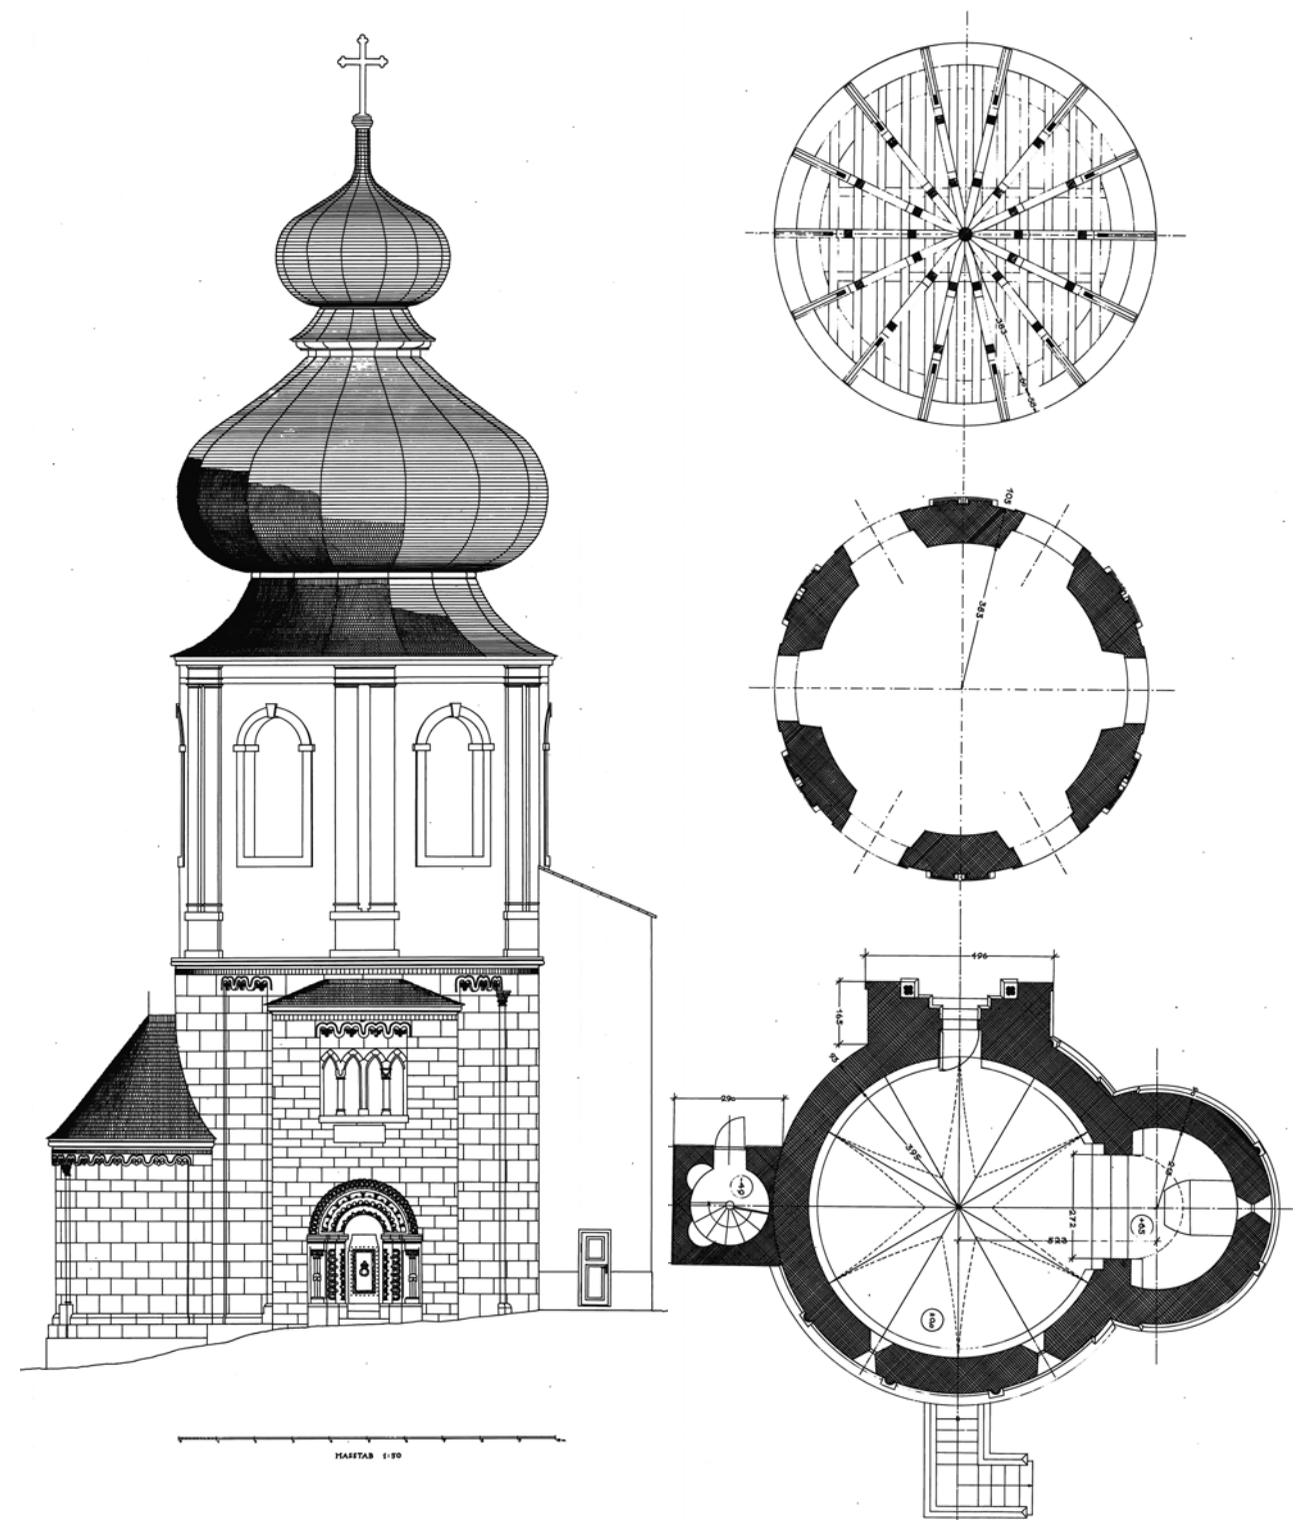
Ansicht und Grundrisse des Karners in Mödling, M 1:200. TU Wien 1949, Archivbestand des Bundesdenkmalamtes Wien.
